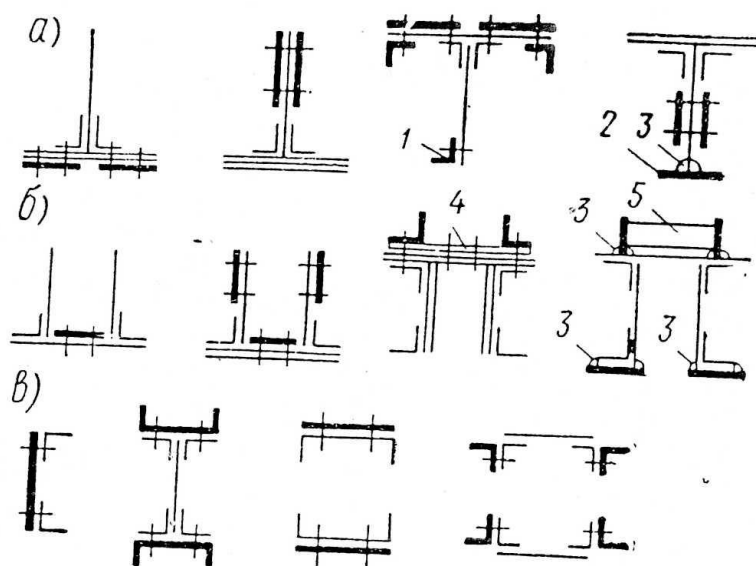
Схемы усиления стержней ферм металлом
